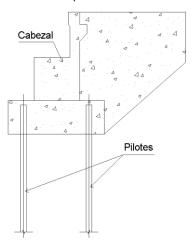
Fundación tipo cabezal sobre de pilotes
